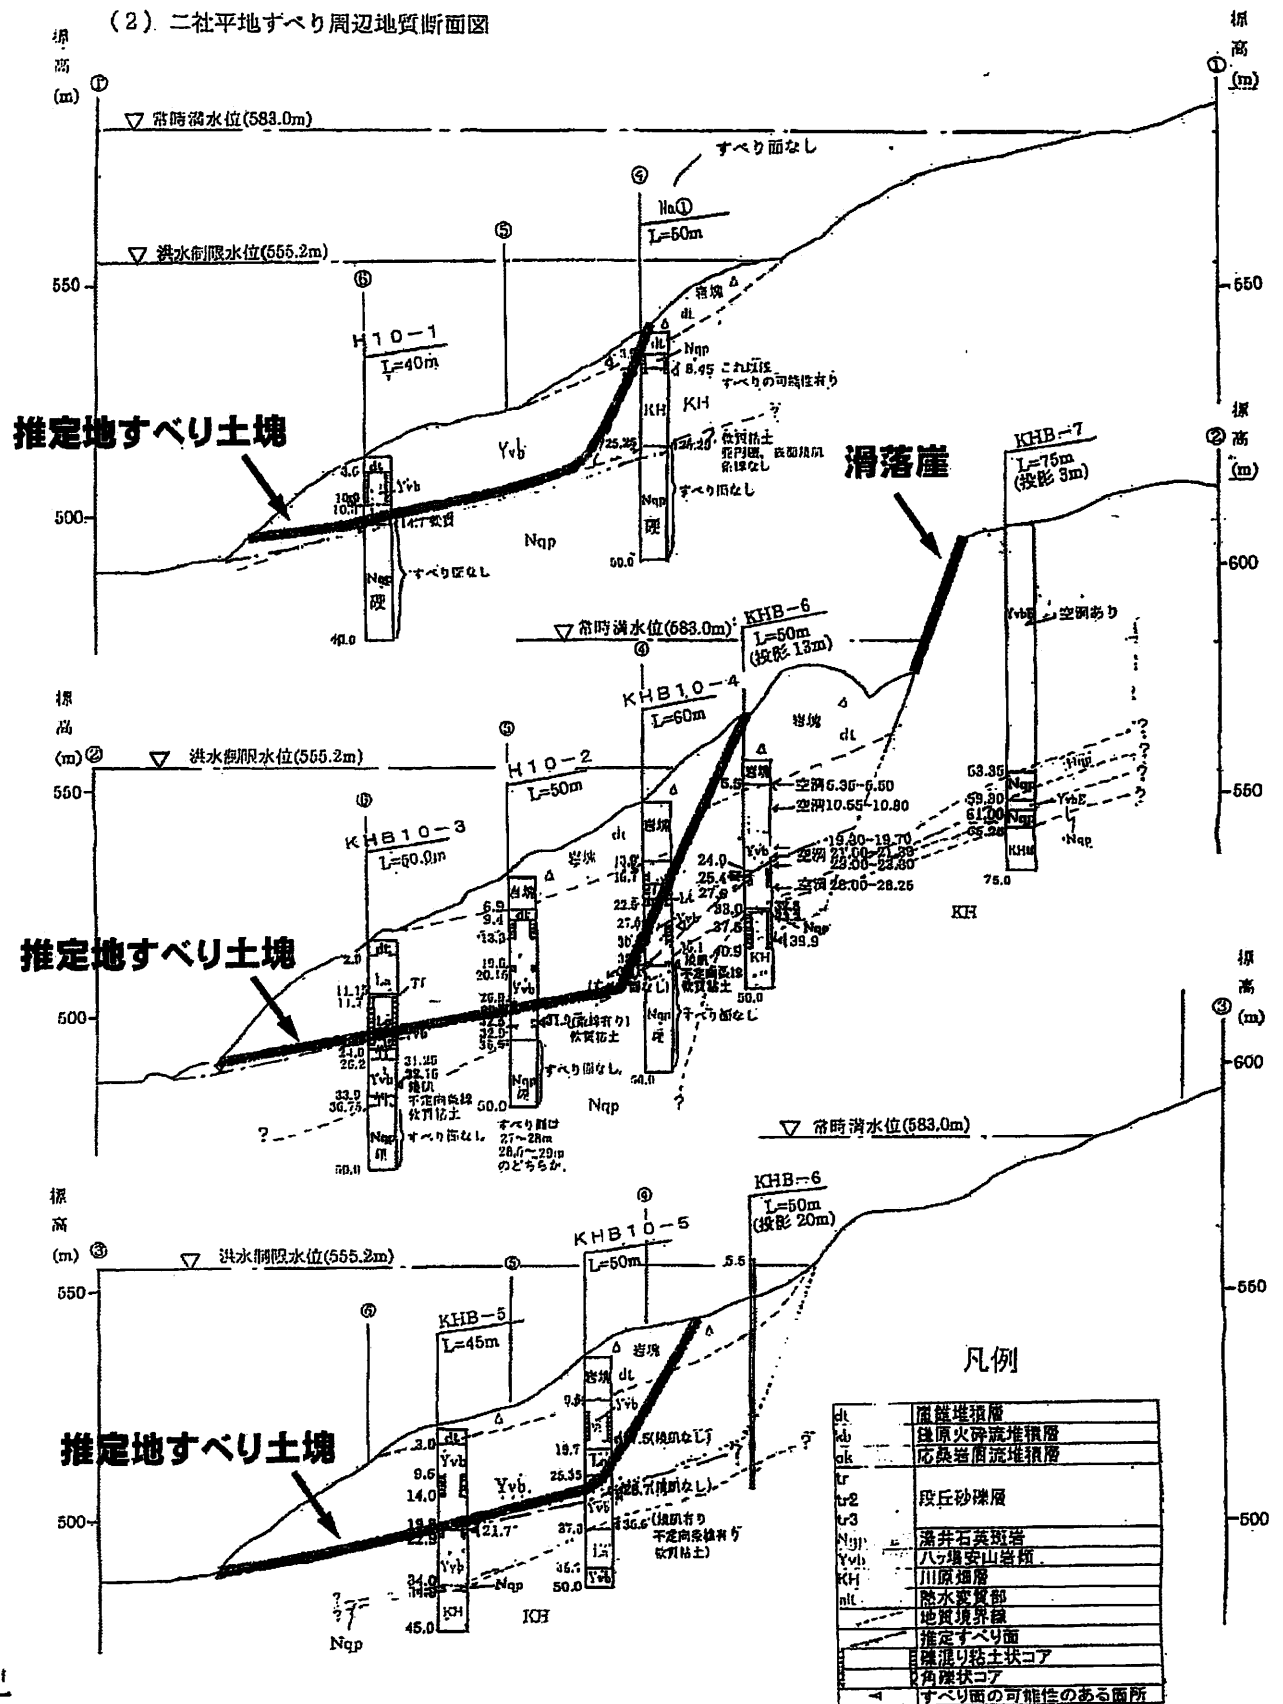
二社平地すべり周辺地質縦断面図 (S=1:1,000)
